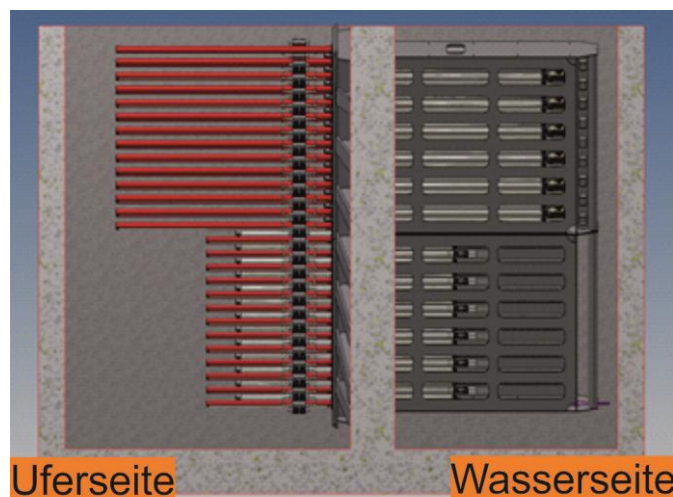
Lagerung der Hydraulikzylinder in Betonschacht (Bild: Albatros Engineering)
